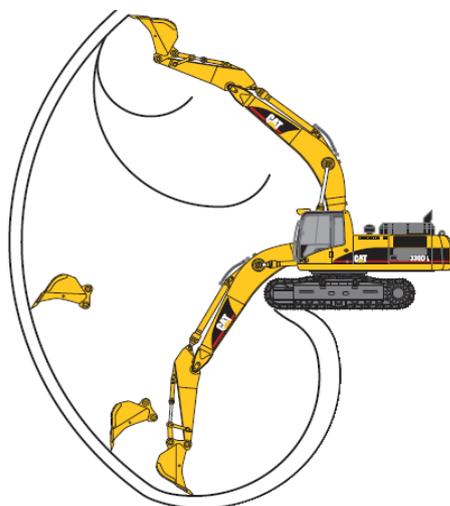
Кинематика движения ковша экскаватора с обратной лопатой
